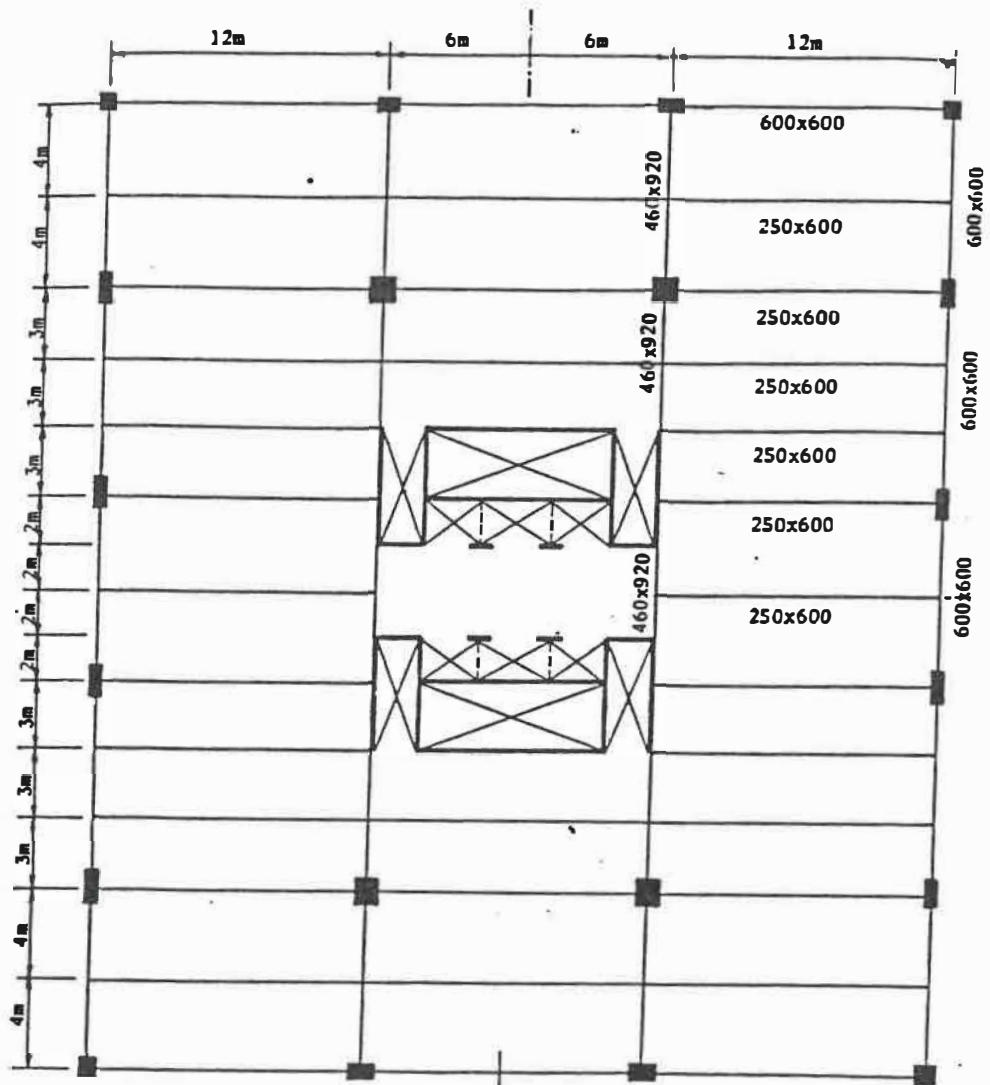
Vue en plan d'un plancher typique de l'édifice de l'exemple 2.
